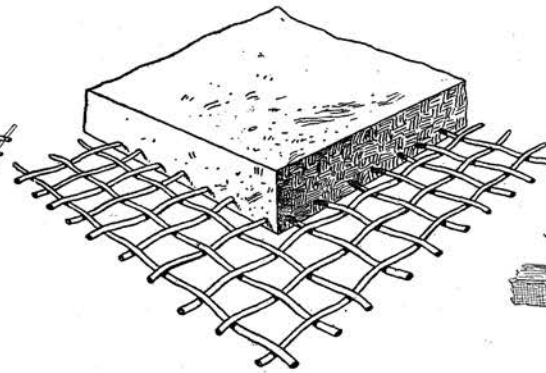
Losa de hormigón armado, sistema *Cottancin*.
